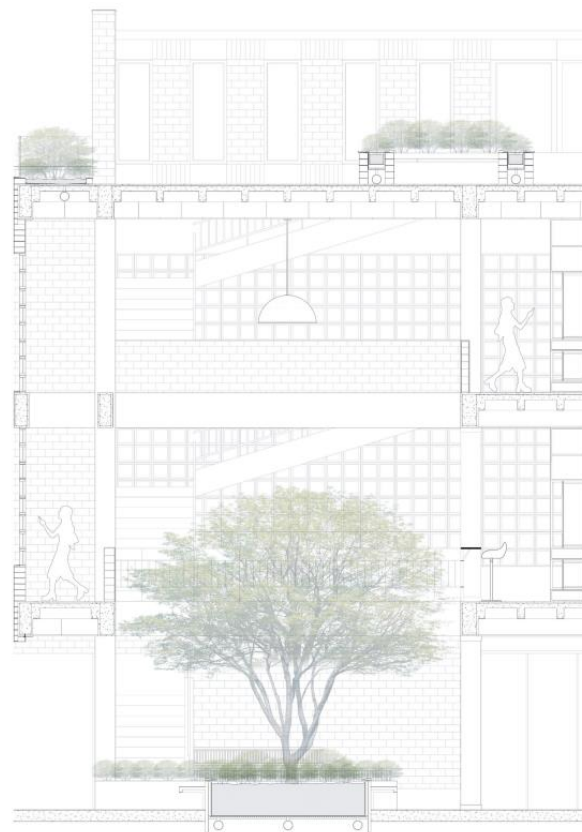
Corte transversal B-B. Por: Elaboración propia.
